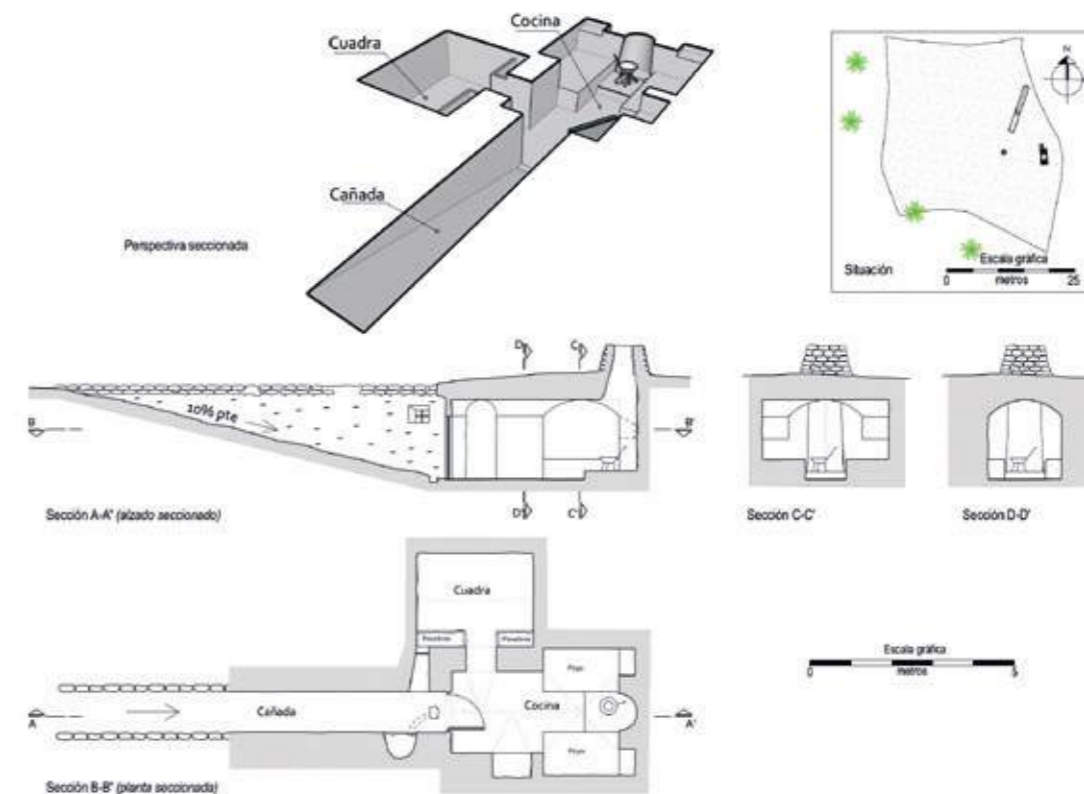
Perspectiva seccionada, planta, secciones transversales y longitudinal de la cueva del Erizo, Daimiel
